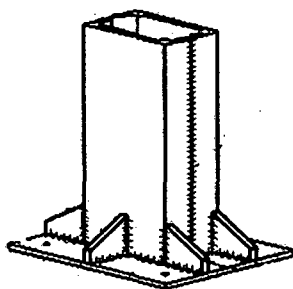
Acero laminado en caliente de sección en forma de tubo cuadrado. (Referencia, José Agudelo Bravo-2013, Metallic structure, 34P).
